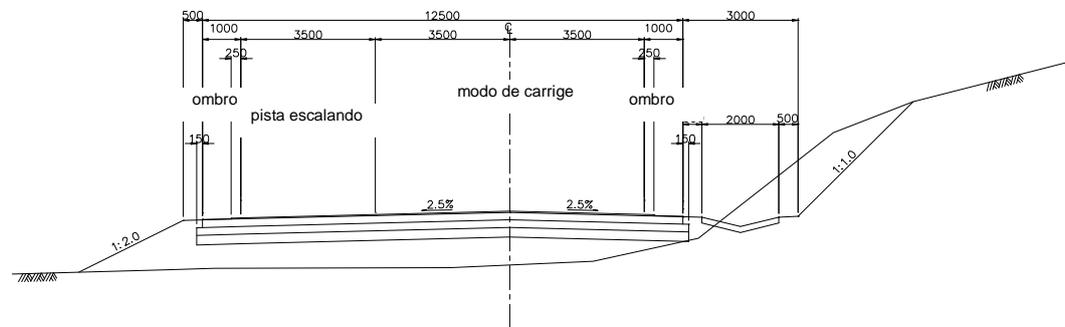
Corte Transversal Proposto para Secções Ascensionais
